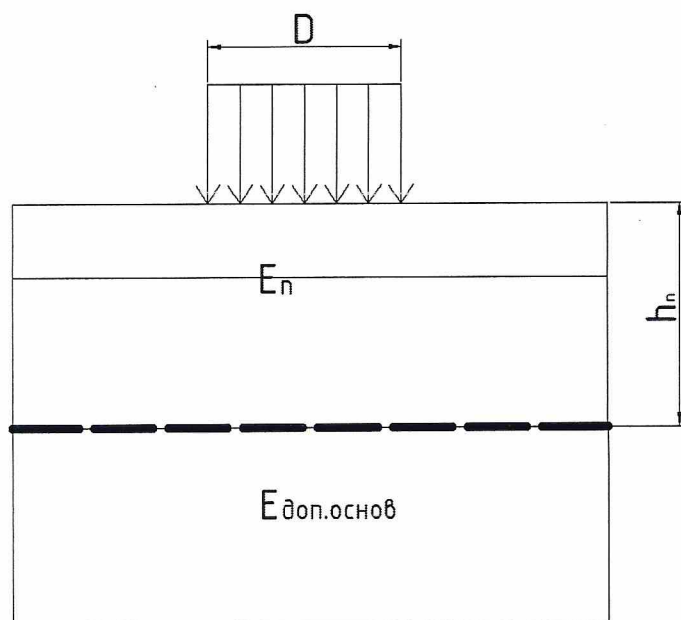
Расчетная схема дорожной одежды переходного и низшего типов, армированной георешеткой.
